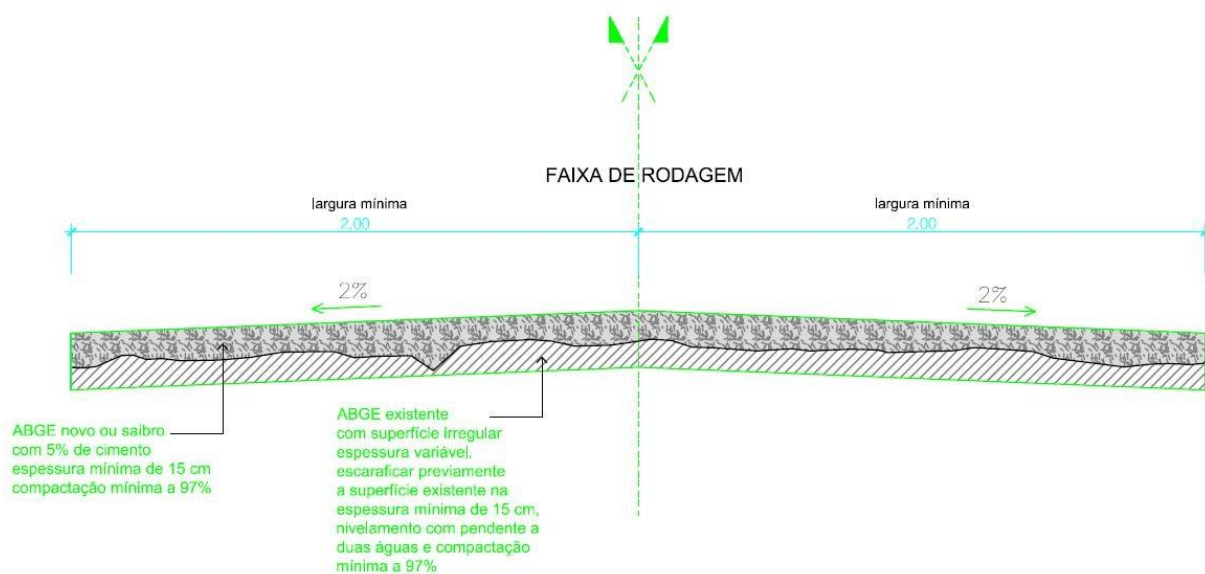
Corte de pavimento tipo reabilitado com ABGE com cimento³²
